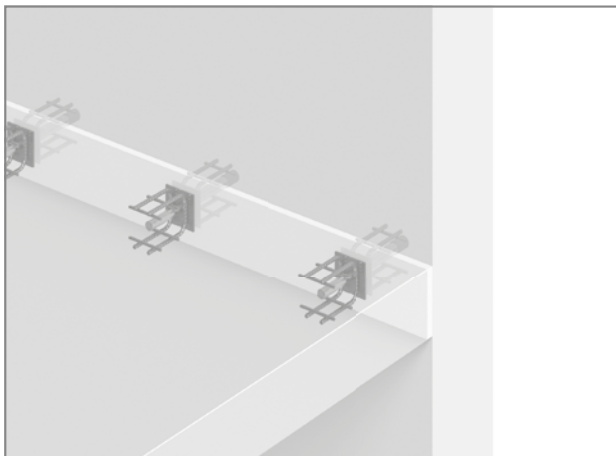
Schöck Dorn tipo SLD: raccordo soletta-parete
